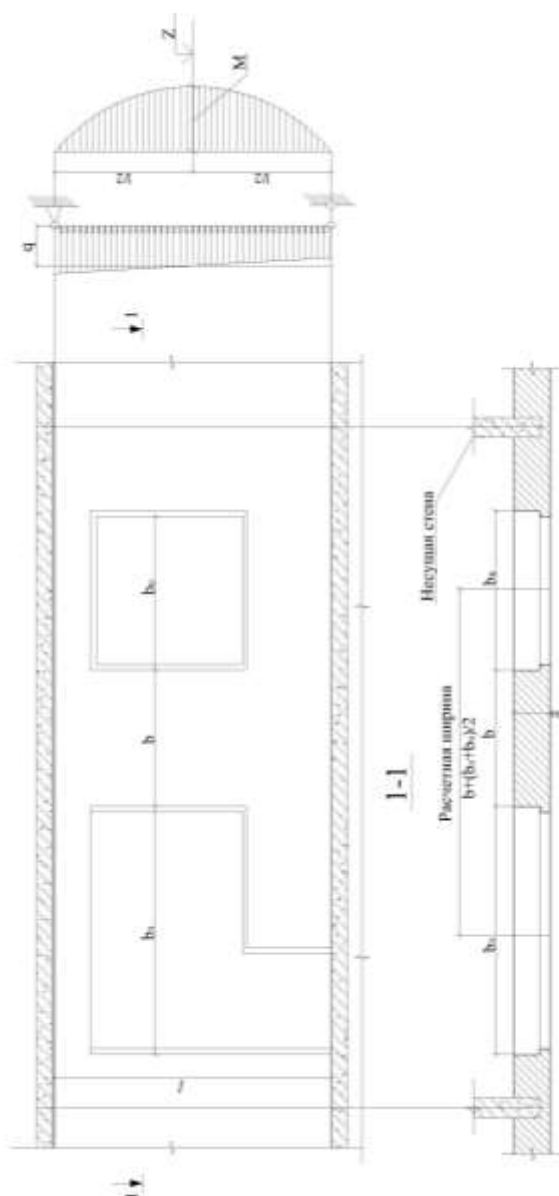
К расчету простенка на ветровую нагрузку
